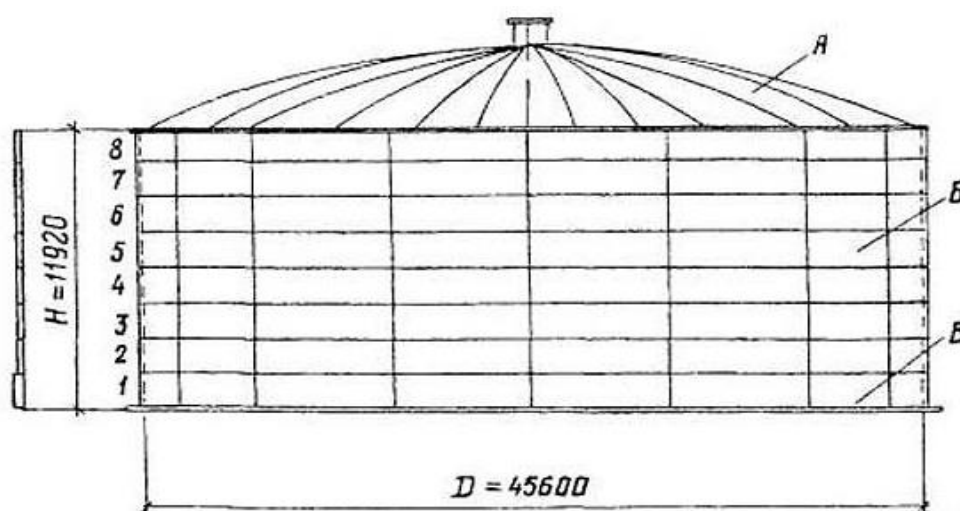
Габаритный чертёж бака-аккумулятора БАГВ-5000
